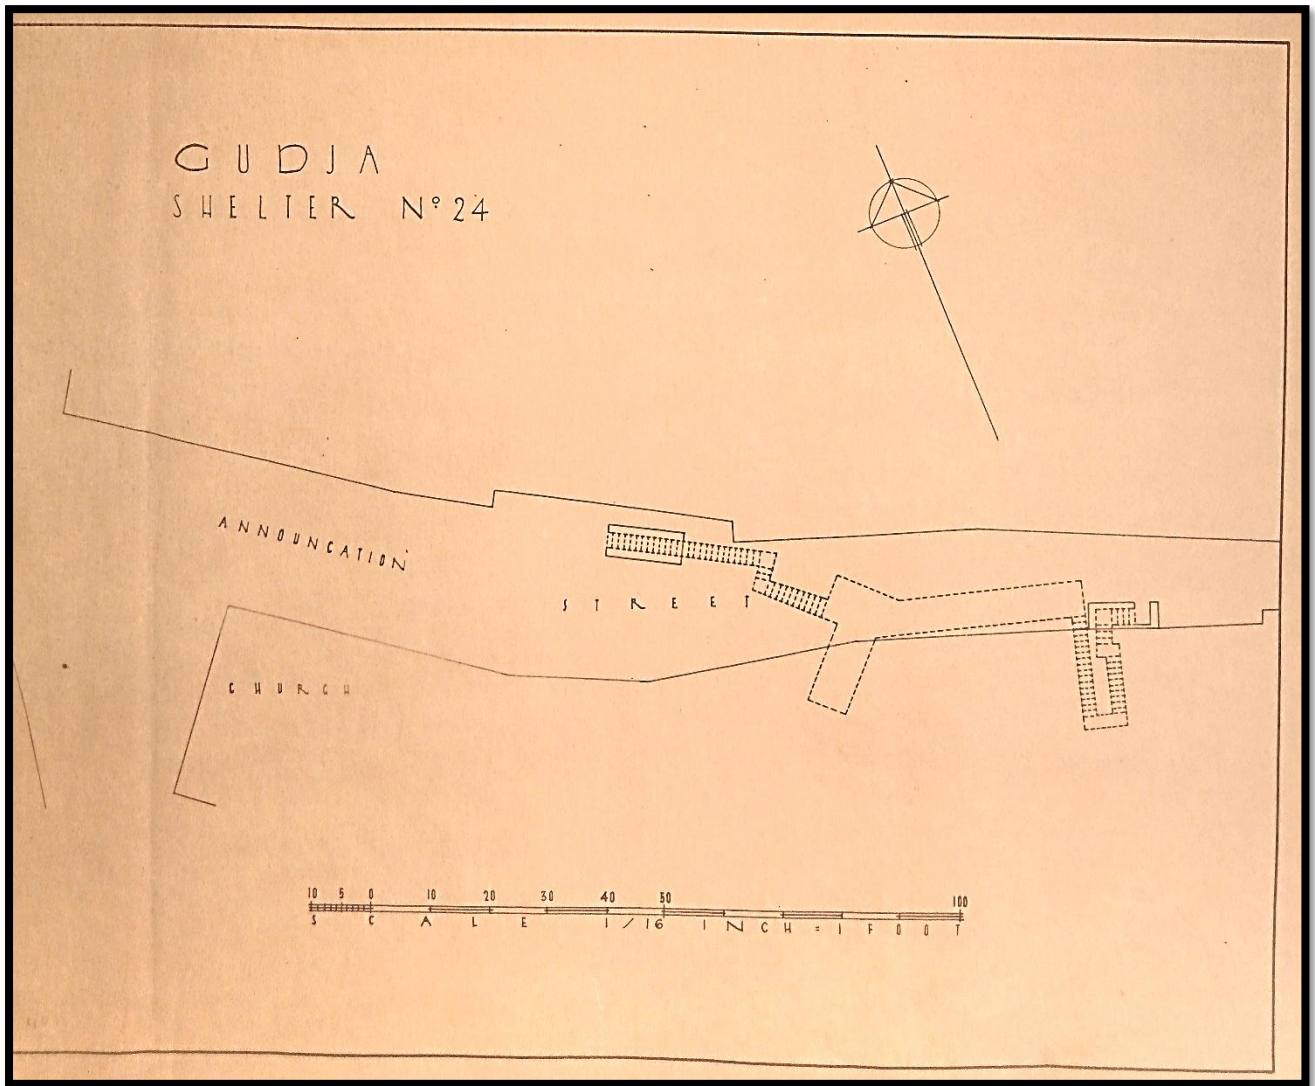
Planta do Abrigo nº24 "Annunciation Street – Church."
